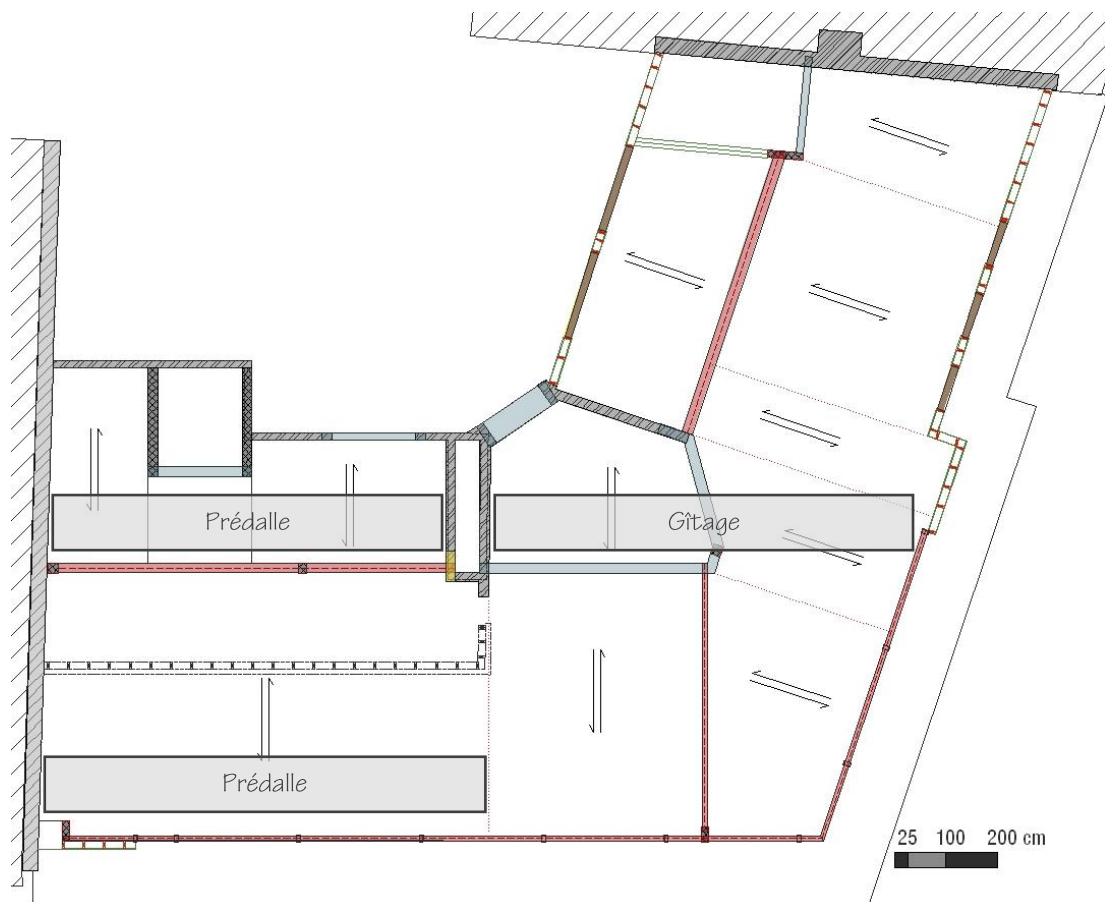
Plan de stabilité, haut 2<sup>e</sup> étage (Source: Bureau JZH & Partners, 2010)
